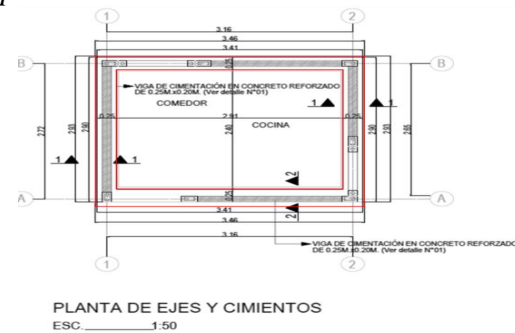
armado y figurado de vigas de cimentación y columnas (Víctor, cocina)
